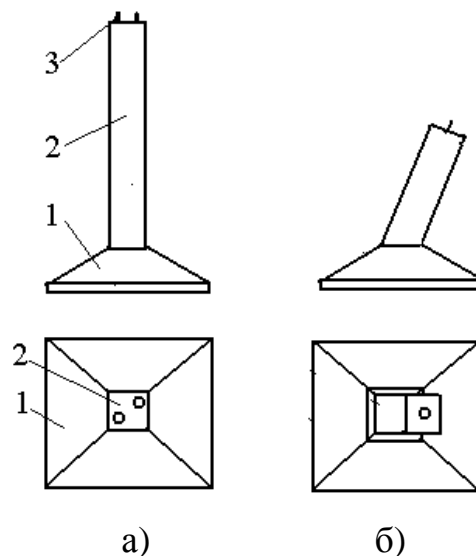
Збірні фундаменти: а - прямий; б - похилий.
